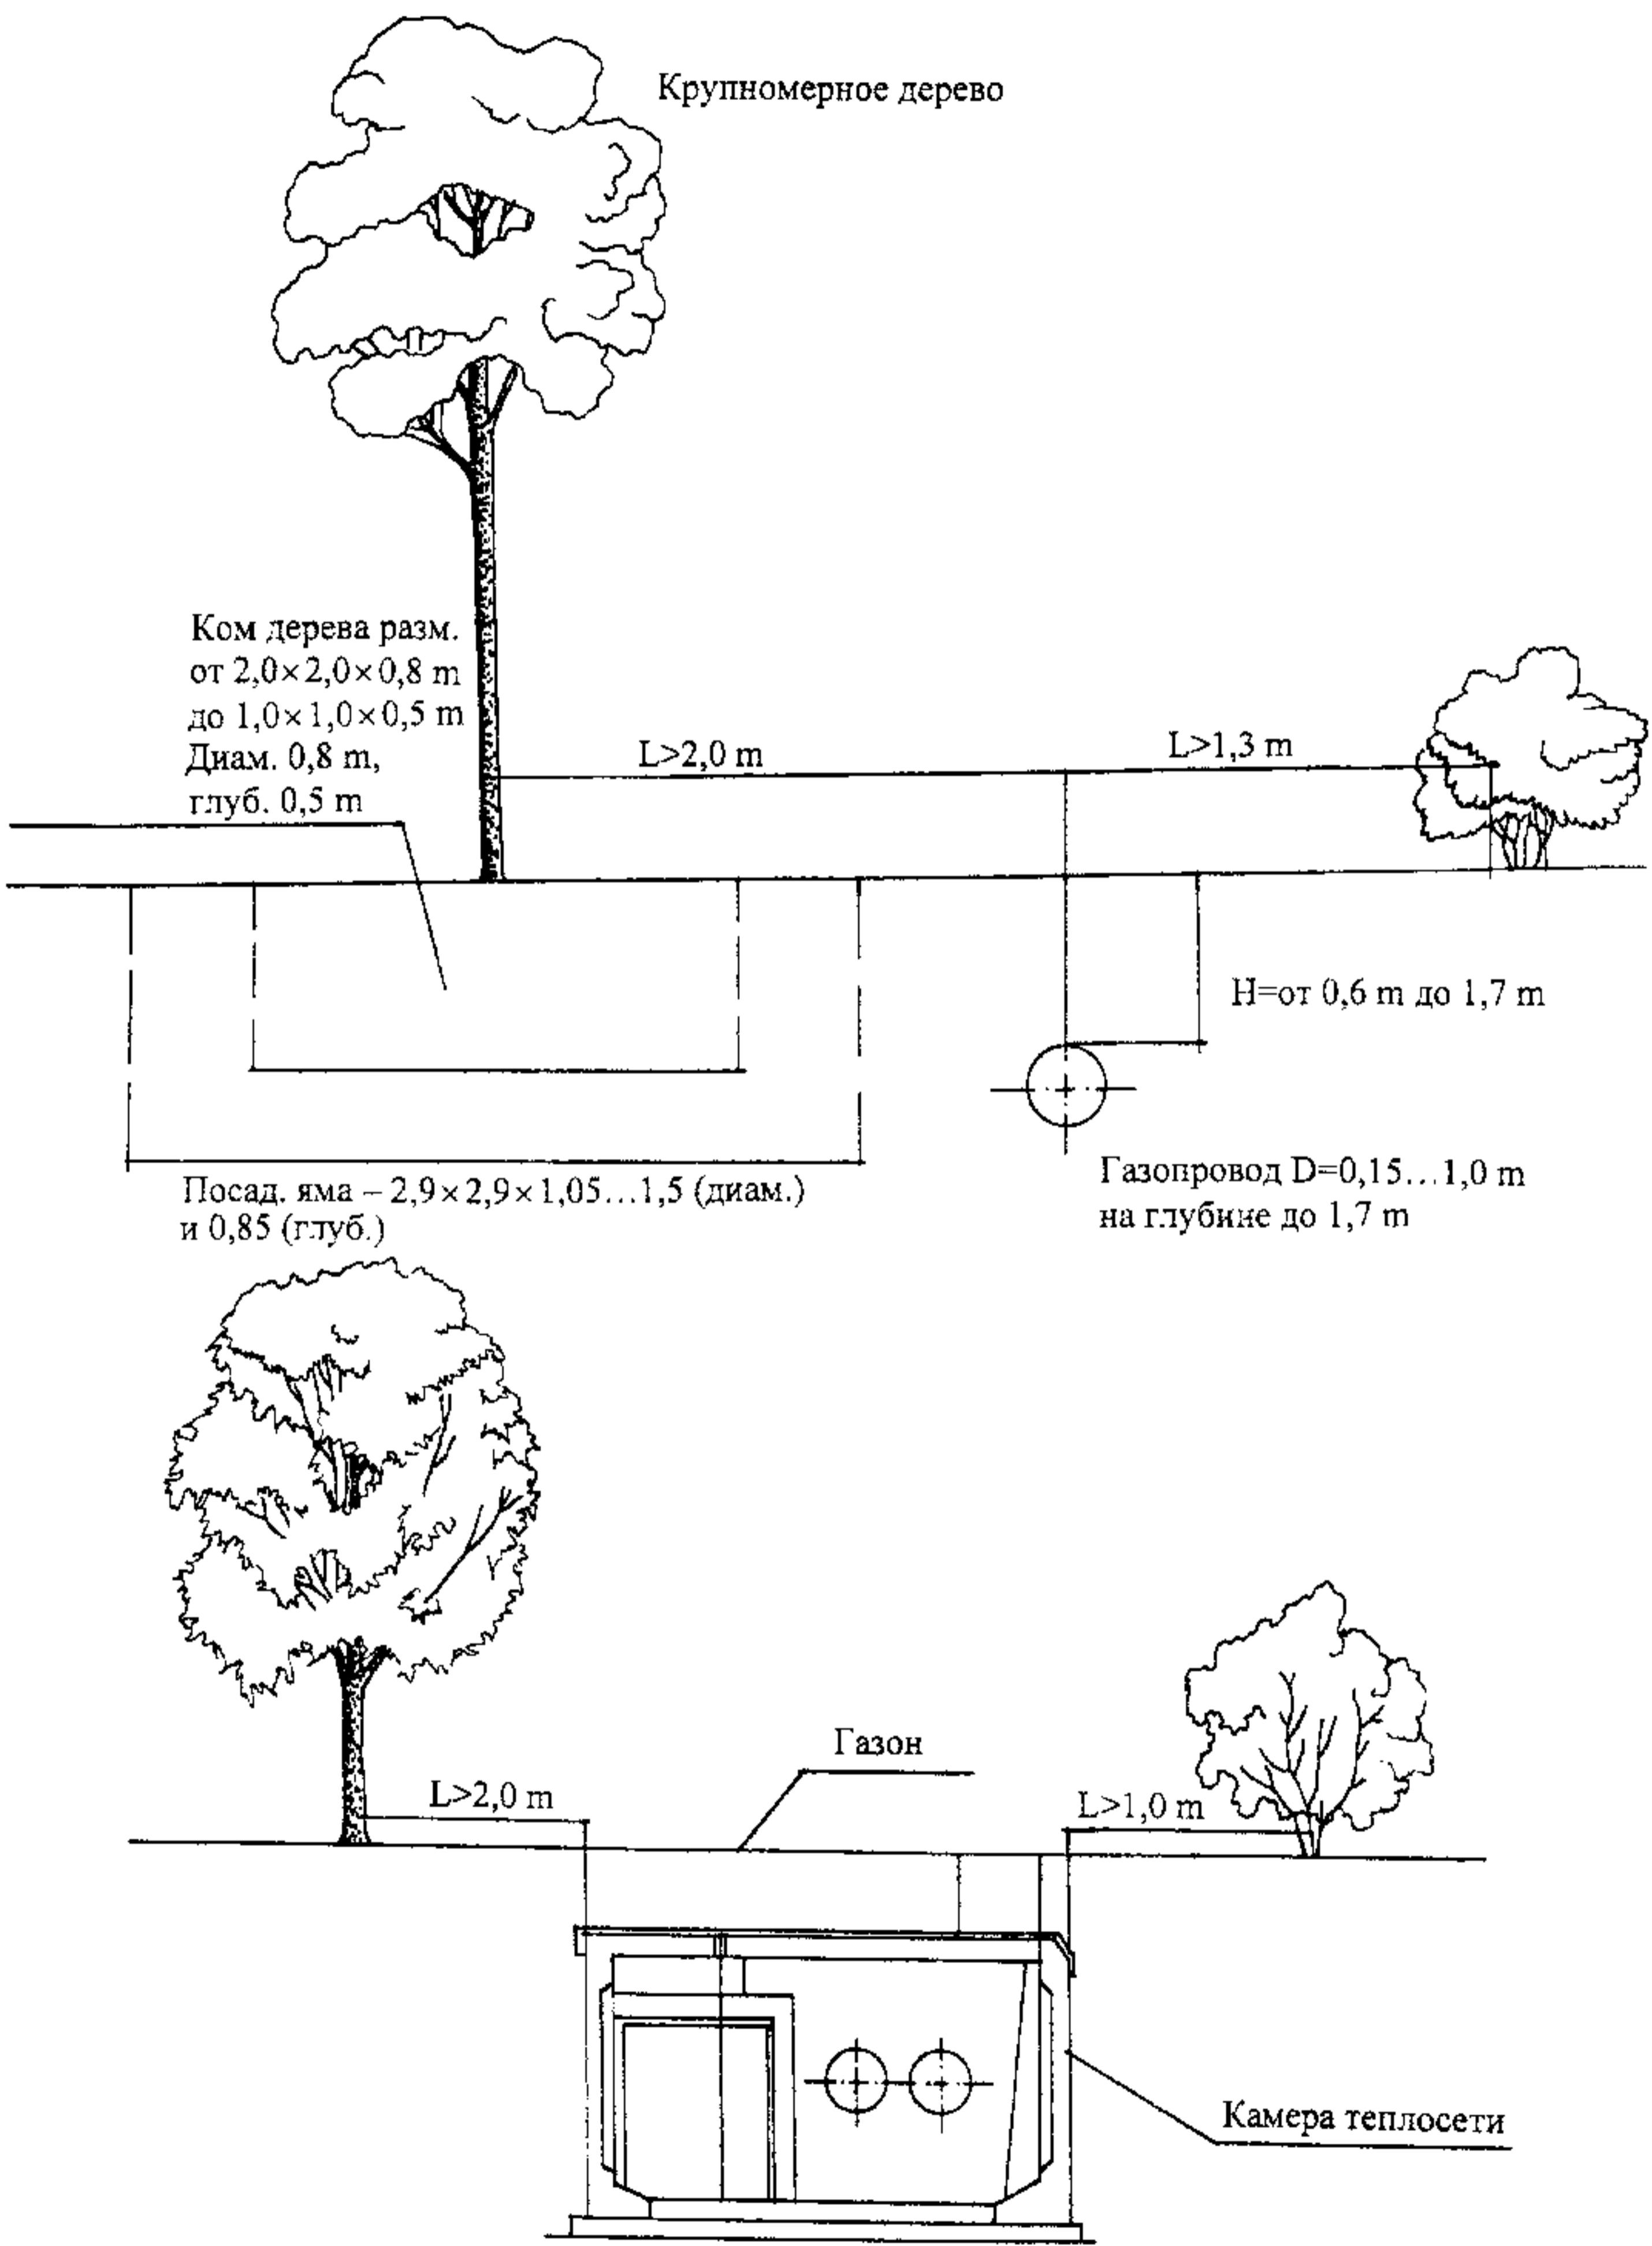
Размещение насаждений в зоне газопровода и камер теплосети
